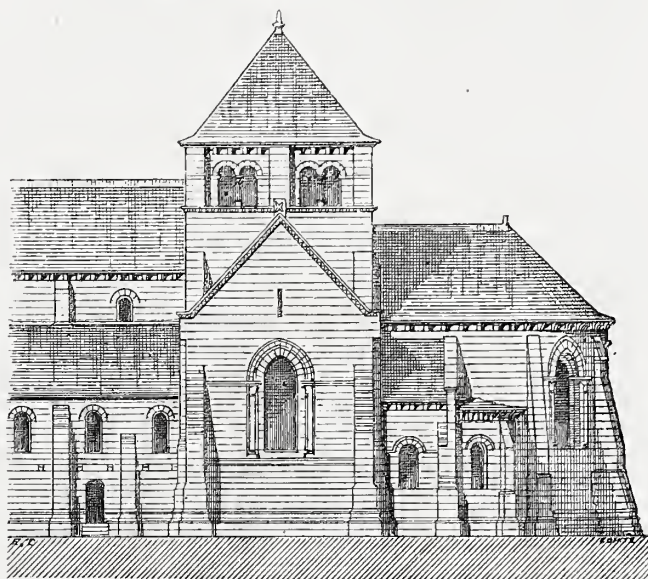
Façade latérale sud, à 0,0025 pour mètre.
